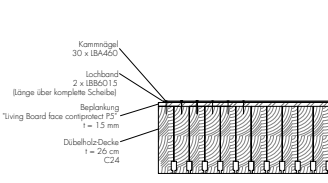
Zugstoß Dachdeckenscheibe II Spannrichtung
